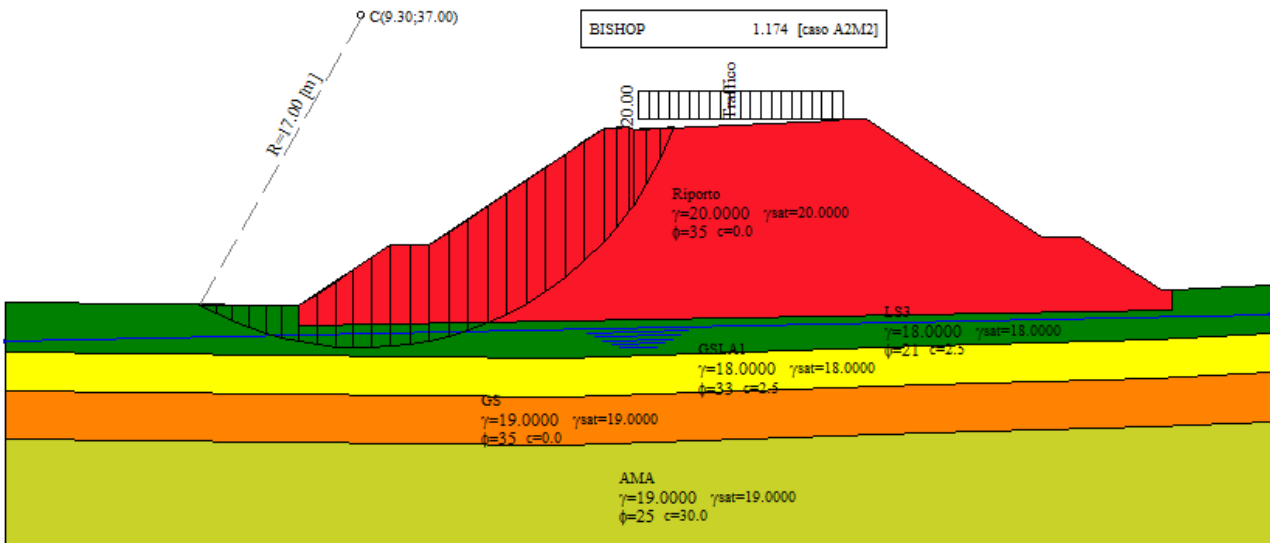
Verifica di stabilità globale - condizione statica drenata
